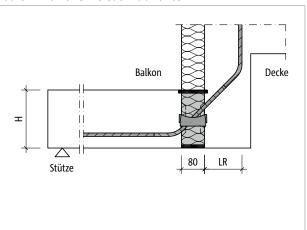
Schöck Isokorb® T Typ QL-WO: Balkon mit Höhenversatz nach unten und Aussendämmung
